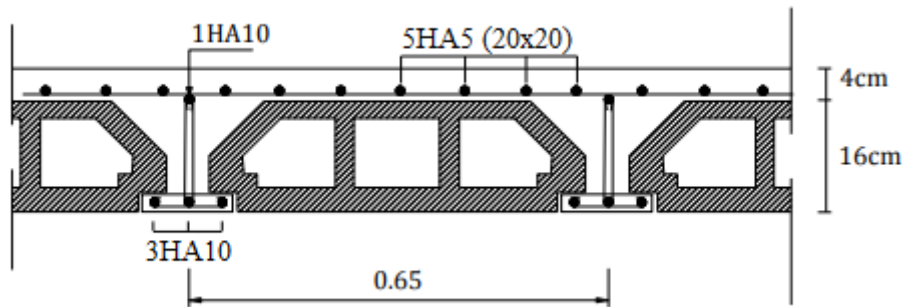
schéma Ferrailage des poutrelles en travée
